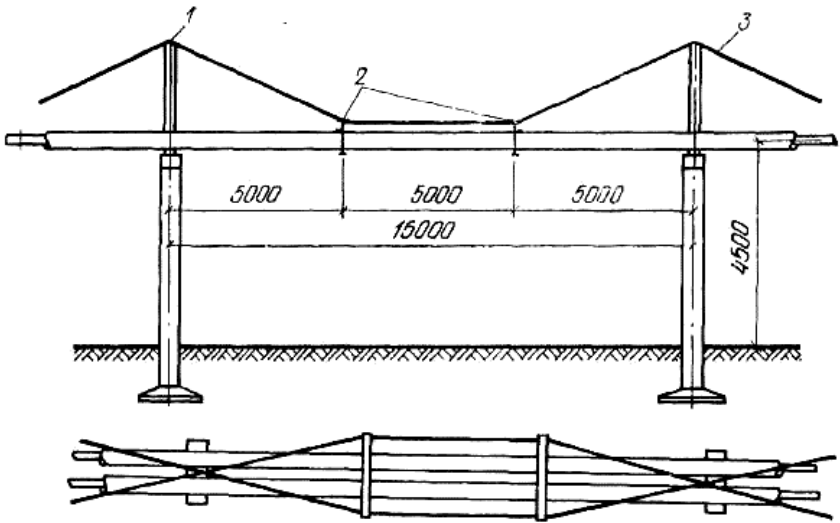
Надземный трубопровод подвесной конструкции на высоких опорах:
